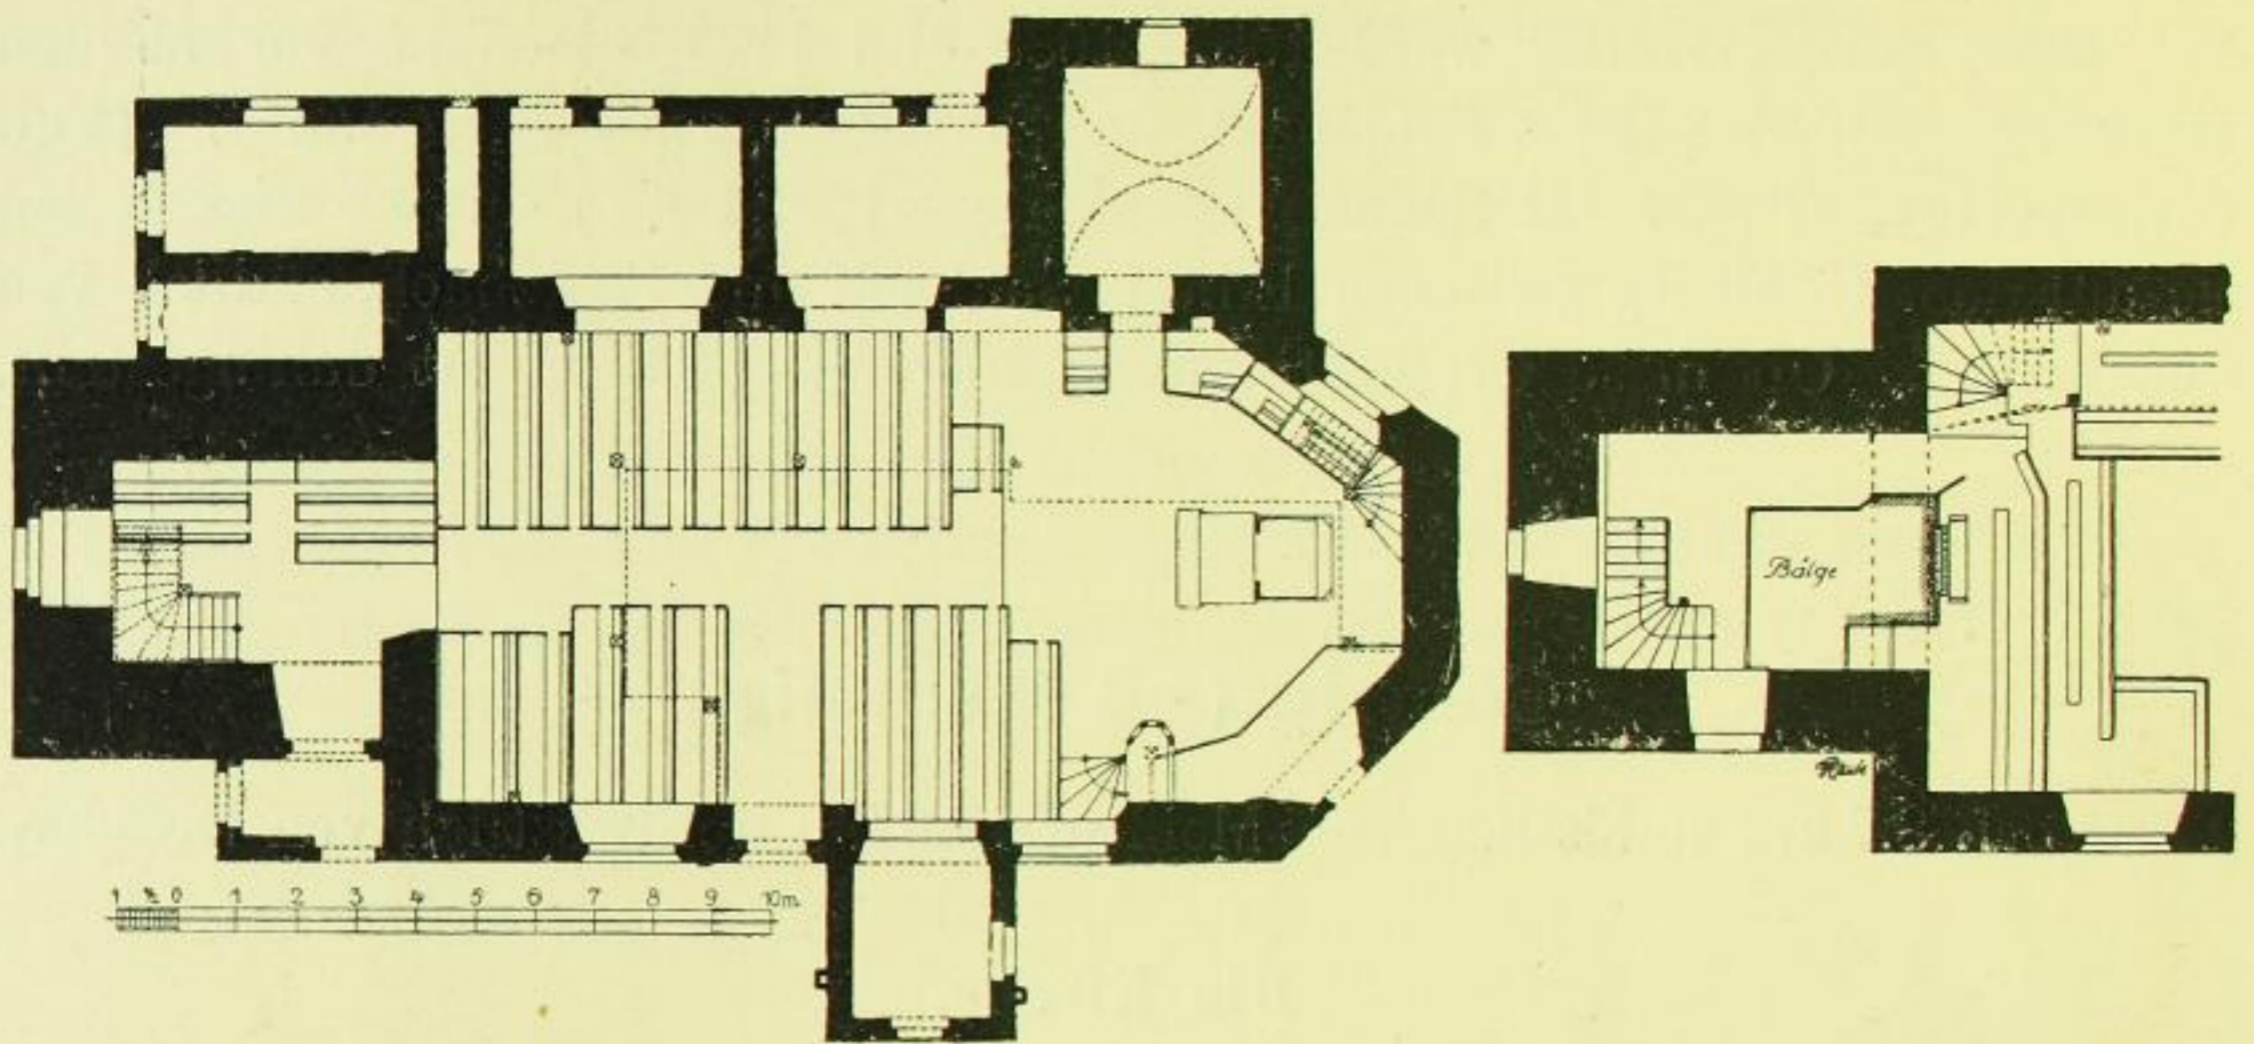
und 161. Coswig, Kirche, Grundriß des Erdgeschosses, Turmgrundriß des Obergeschosses.
